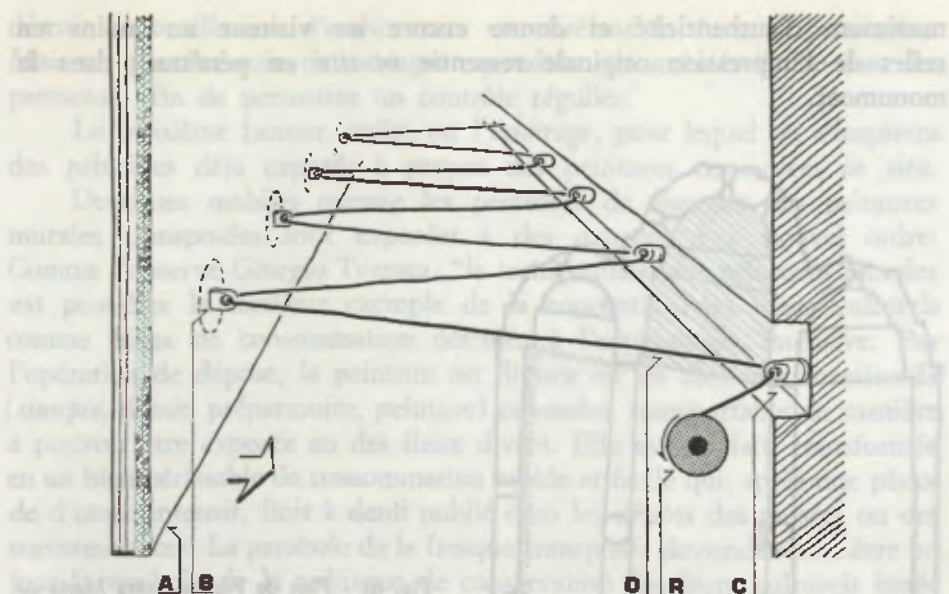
Fixage du nouveau support à la paroi du mur au moyen de câbles couissant par les anneaux.
